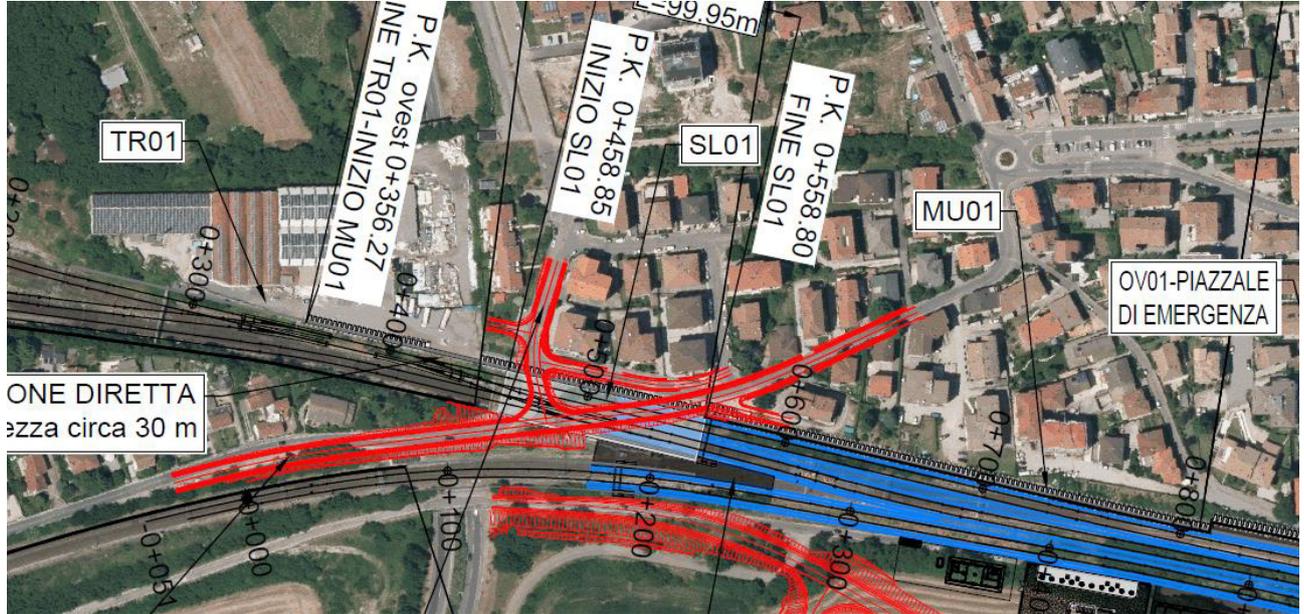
NV01 – Stralcio planimetrico su ortofoto di Via Piatti
